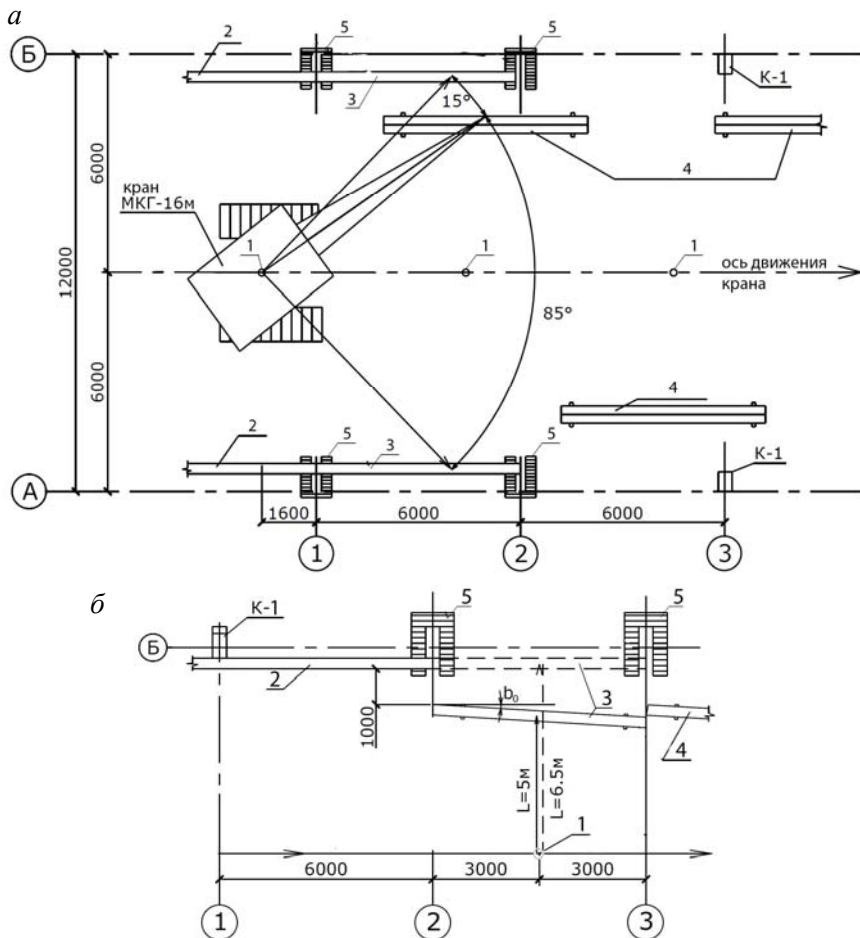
Технологические схемы монтажа подкрановых балок:
